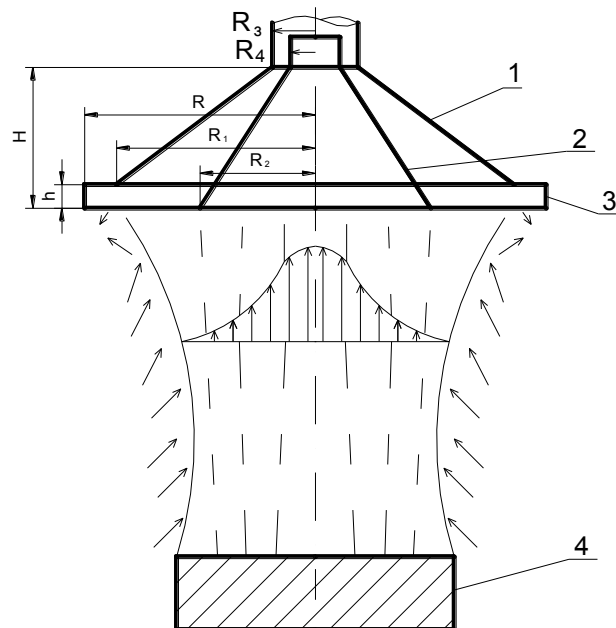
Вентиляційний зонт з активним центром [12]: 1 – корпус зонта; 2 – порожниста конічна вставка; 3 – кільцевий відступ; 4 – джерело теплогазовиділень
